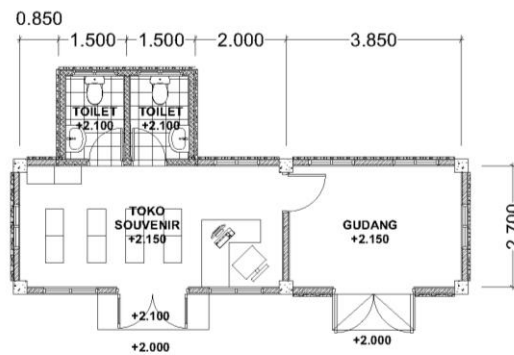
Denah Lantai 1 Gedung Cultural Center
